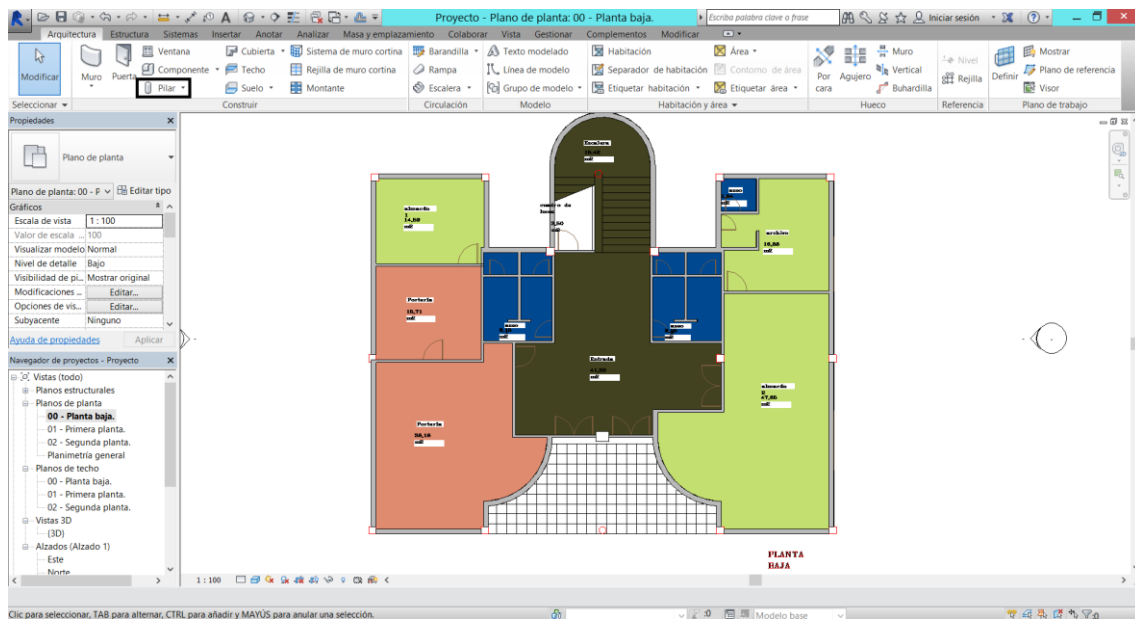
Herramienta pilar. Fuente: Elaboración propia.
